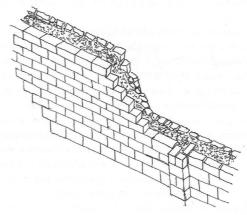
Dibujo constructivo de la tipología de muro B (dibujo de los autores 2013)
